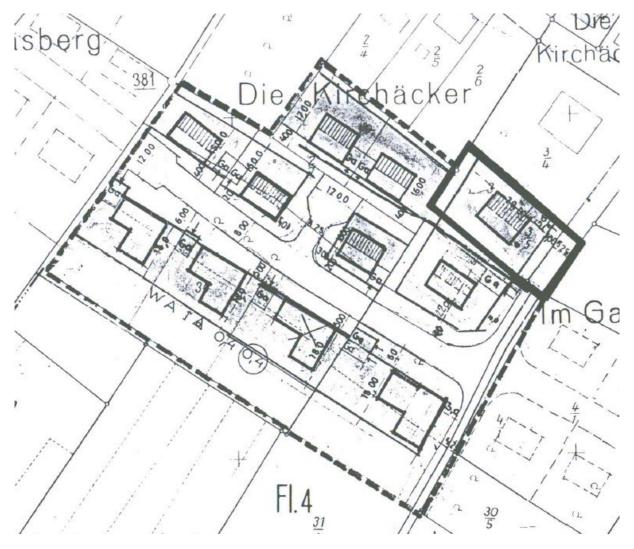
Bebauungsplan "Zotzenbach Flur 4"
